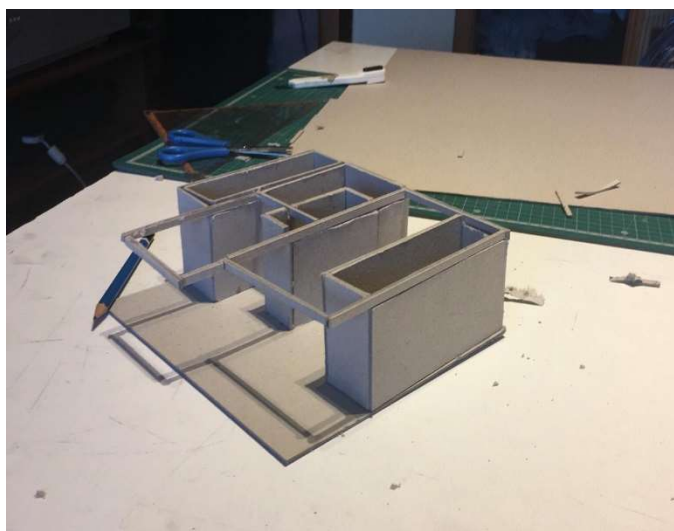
Maqueta Modulo 1:50 – Estudo de Fachada - Final de 2018
